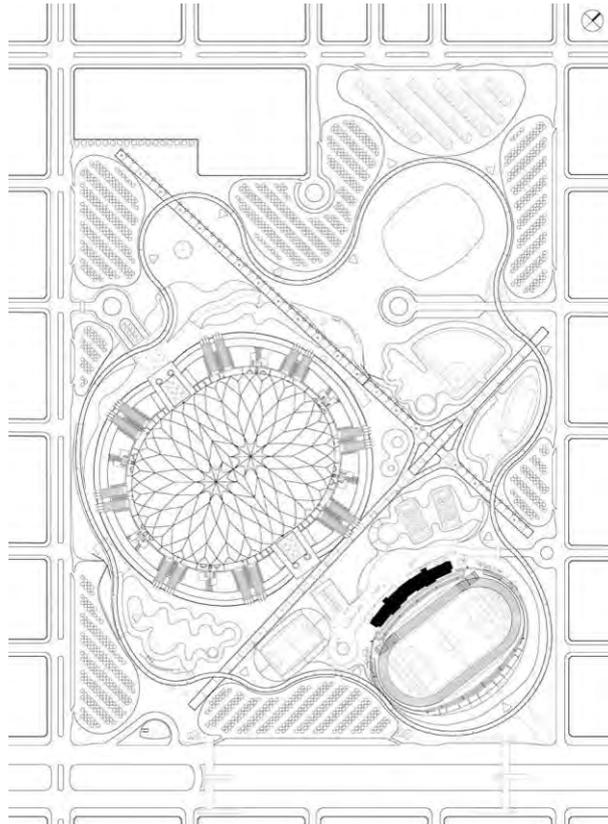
Planta de Conjunto del “Estadio Ciudad de La Plata”, 1998.
